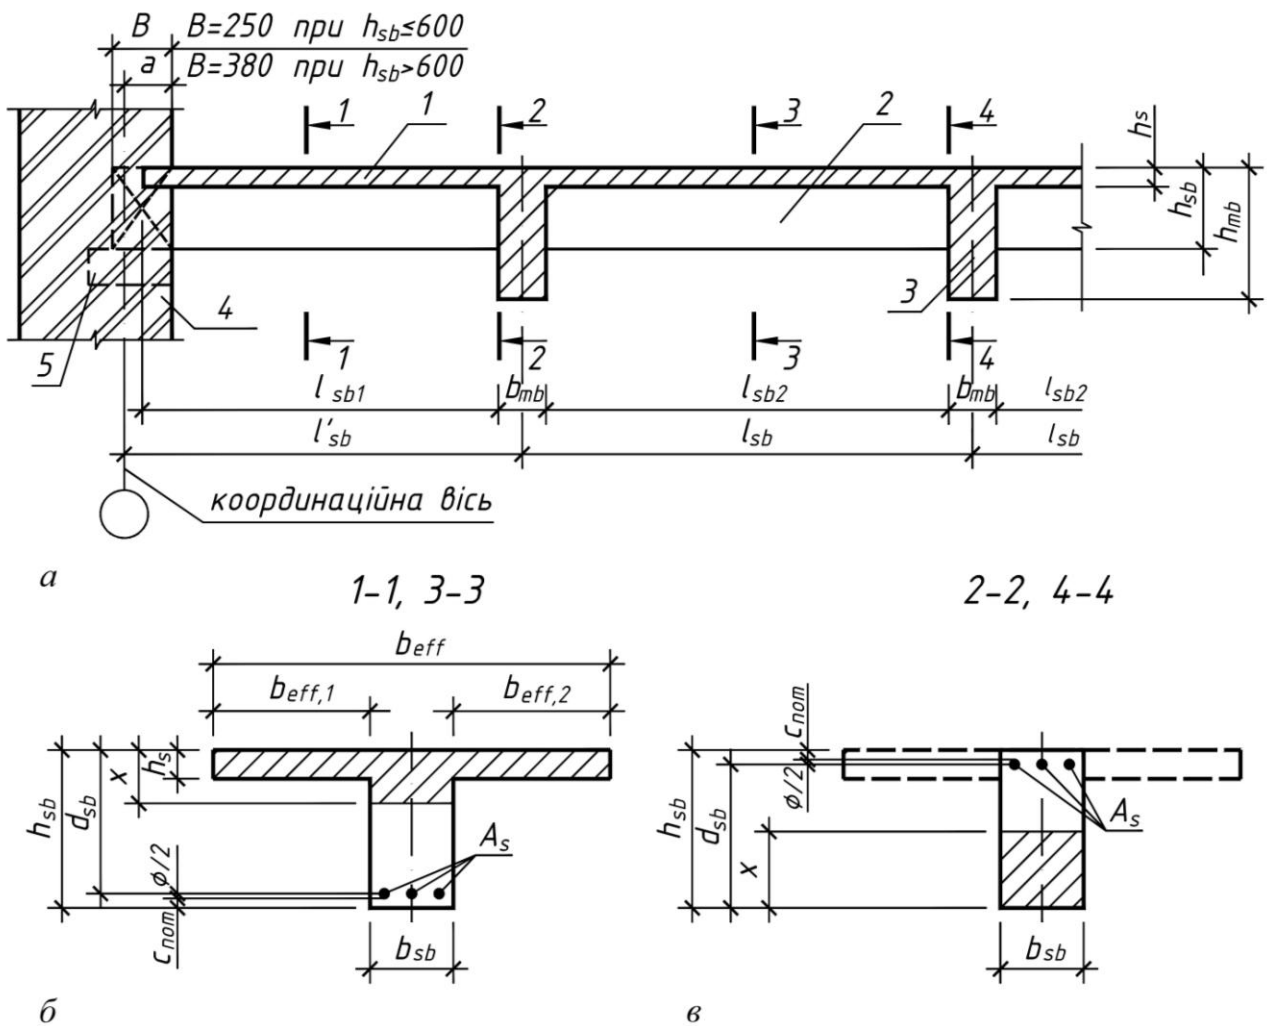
До визначення розрахункових прольотів і розмірів поперечного перерізу другорядної балки: *а* – переріз перекриття вздовж другорядних балок; *б* – переріз з полицею в стиснутій зоні (в прольоті); *в* – переріз з полицею в розтягнутій зоні (на опорі); 1 – плита; 2 – другорядна балка; 3 – головна балка; 4 – стіна; 5 – розподільна залізобетонна подушка
